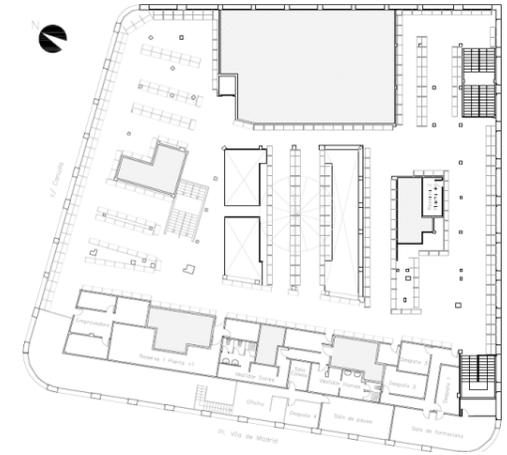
Planta Altell. Font: Elaboració Pròpia
